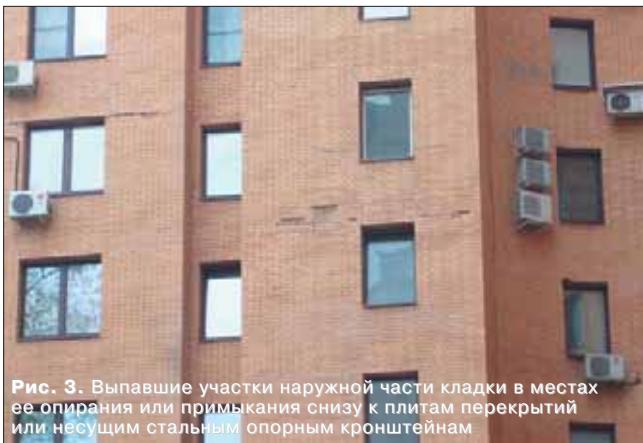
Выпавшие участки наружной части кладки в местах ее опирания или примыкания снизу к плитам перекрытий или несущим стальным опорным кронштейнам
